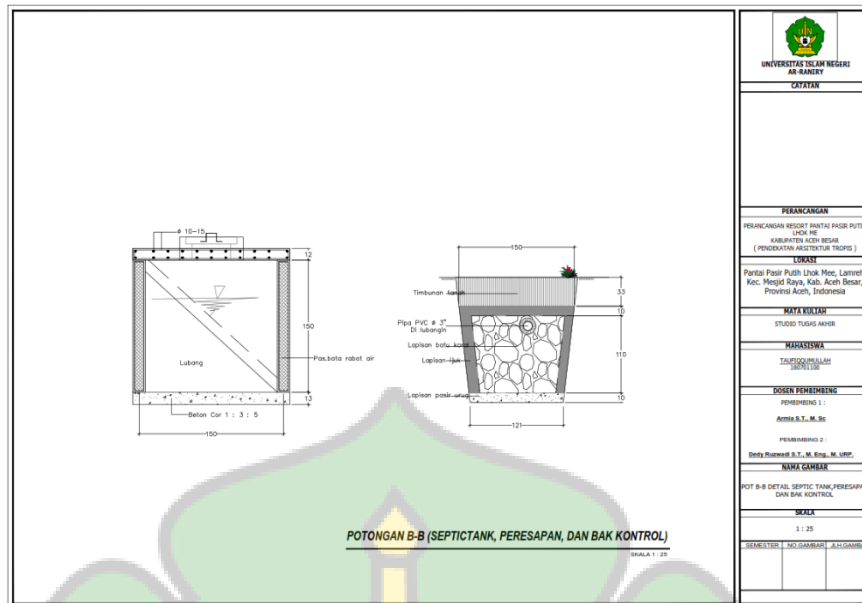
Detail Septictank, Resapan dan Bak Kontrol
